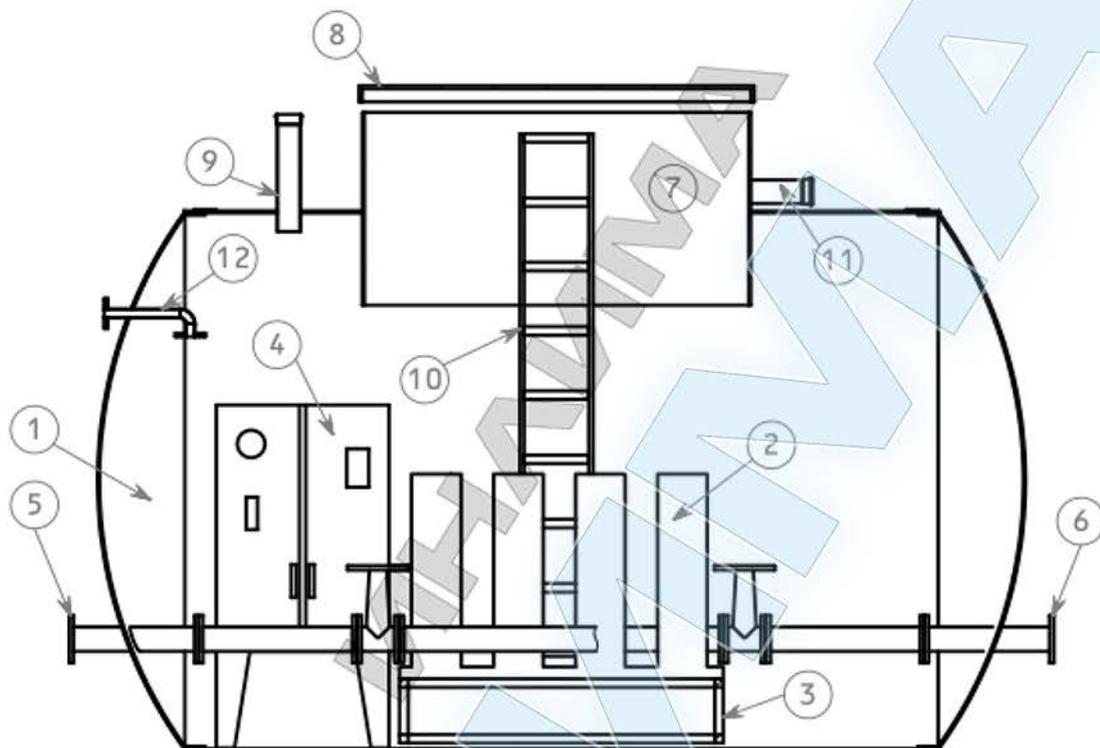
Общий вид (разрез) корпуса насосной станции
